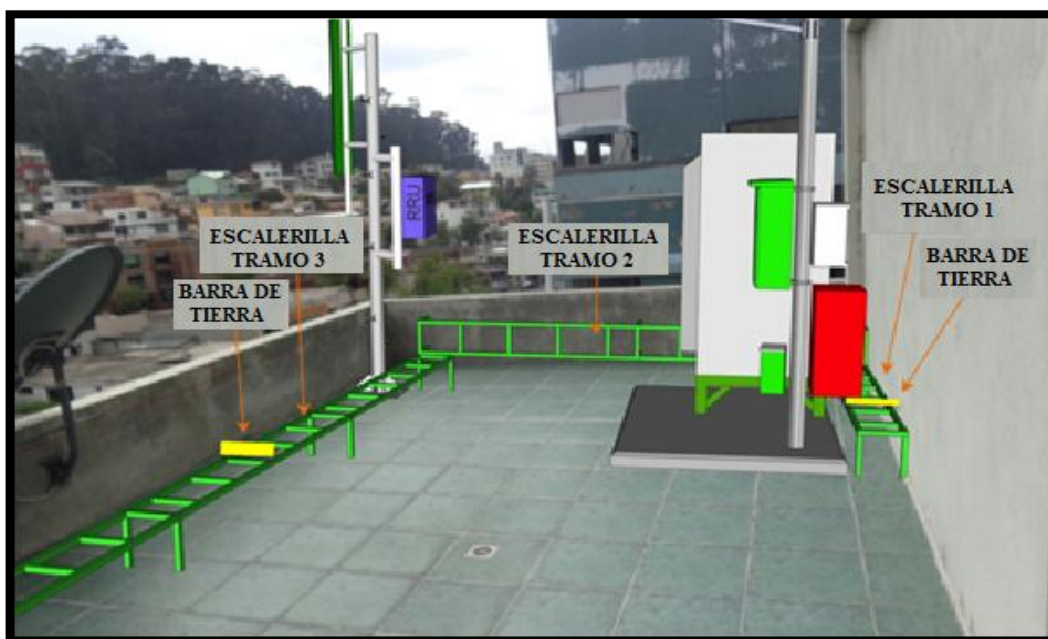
Recorrido de Escalerillas Horizontales y Verticales.
